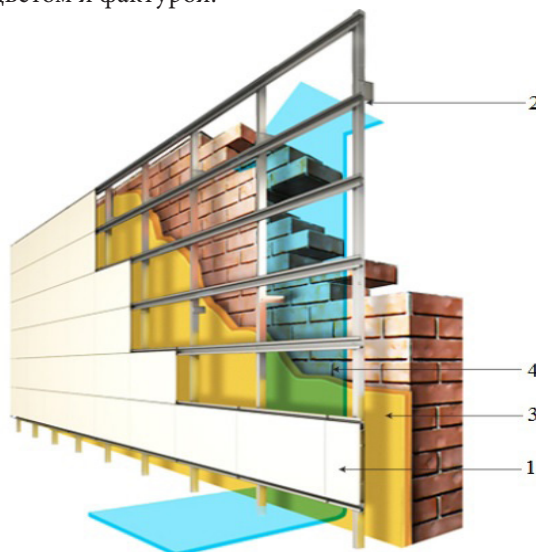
Конструкция вентилируемого фасада: 1 — облицовка; 2 — металлический каркас; 3 — утеплитель; 4 — вентиляционный зазор
